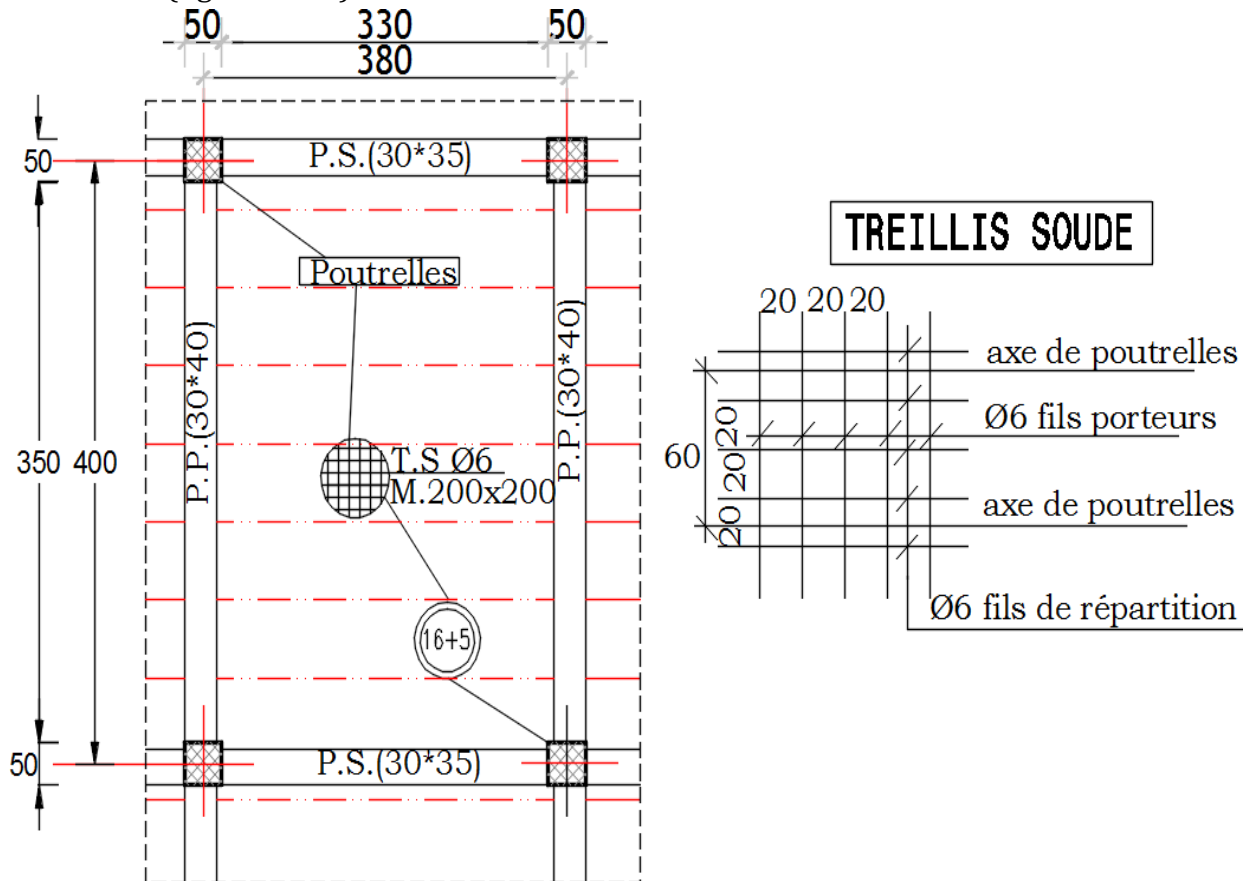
Schéma de ferrailage de La dalle de compression.
